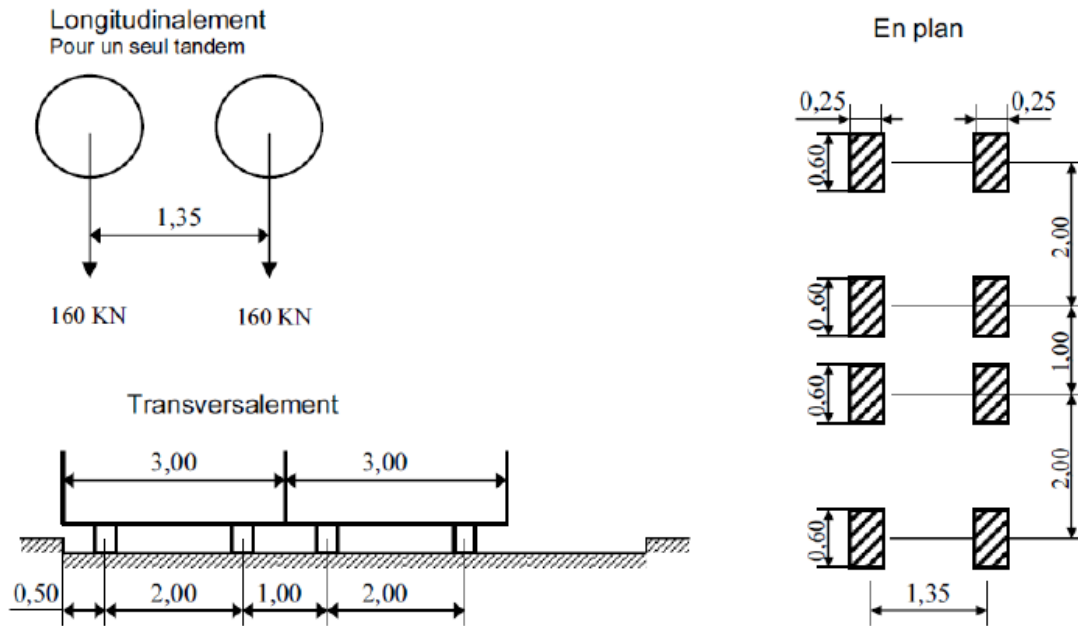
Système Bt longitudinalement, transversalement et en plan.
